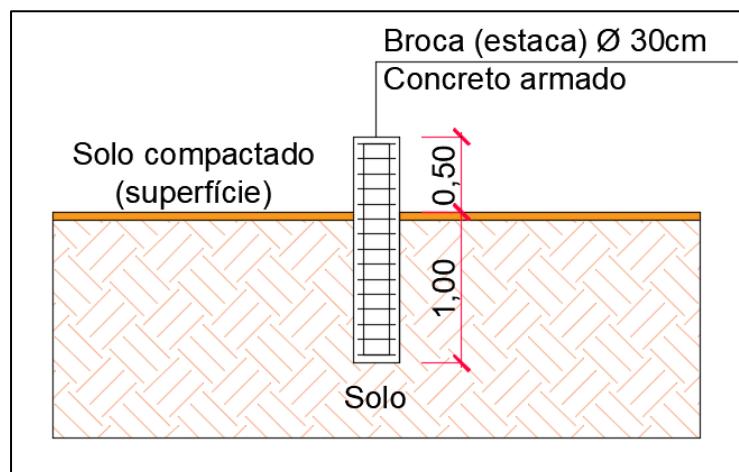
Detalhamento da fundação das estruturas dos painéis.
